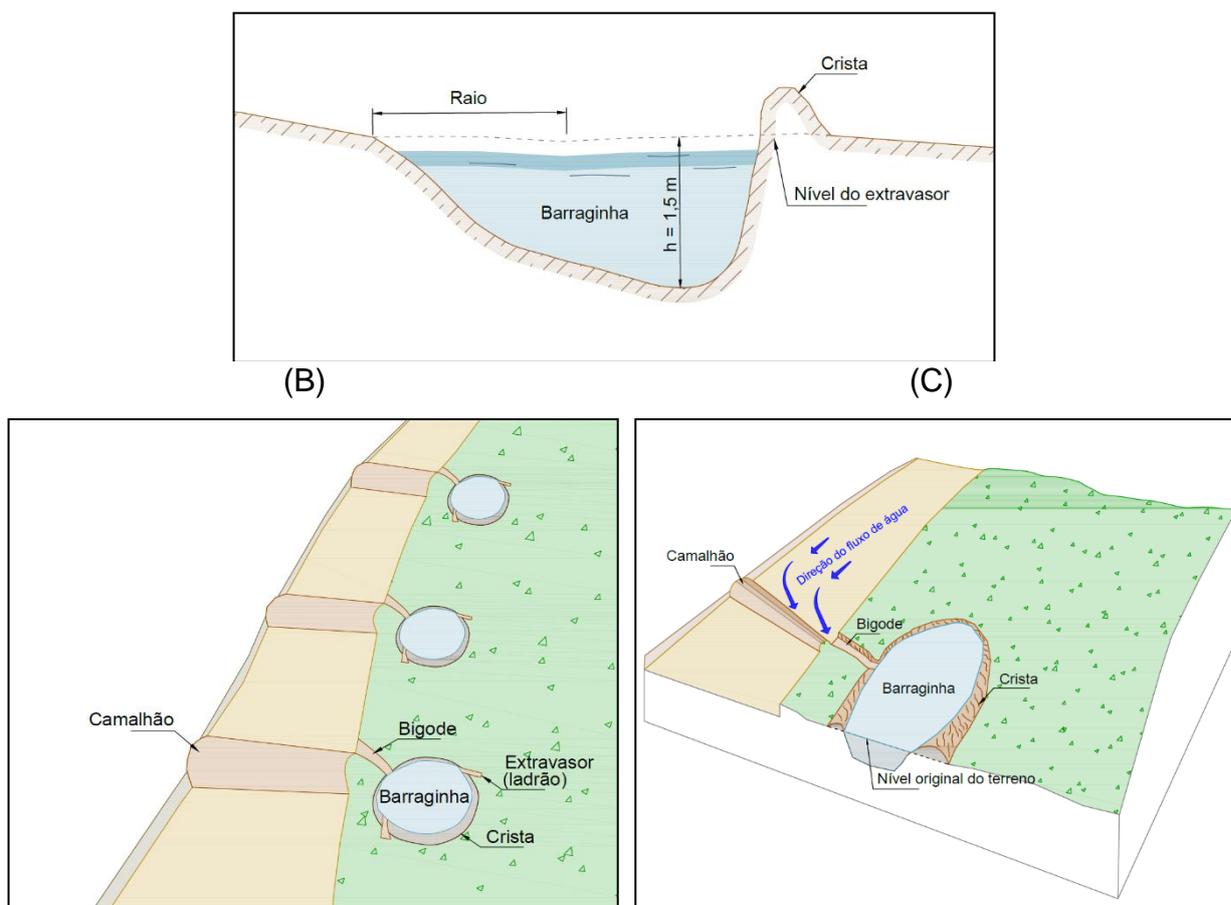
Perfil esquemático de construção de uma barraginha (A), perfil esquemático de conjunto de barraginhas (B) e estruturas de implantação para construção de barraginha (C).
